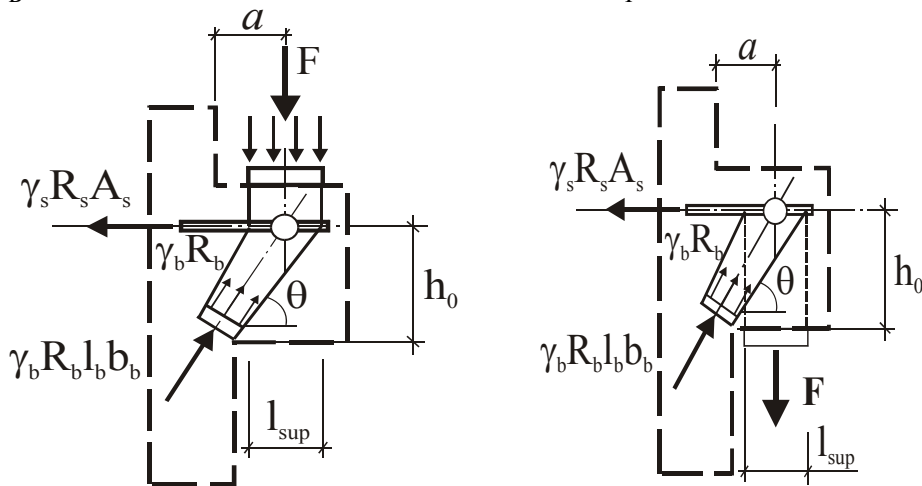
Схема предельных усилий в расчетных сжатых бетонных полосах и растянутом арматурном поясе:
